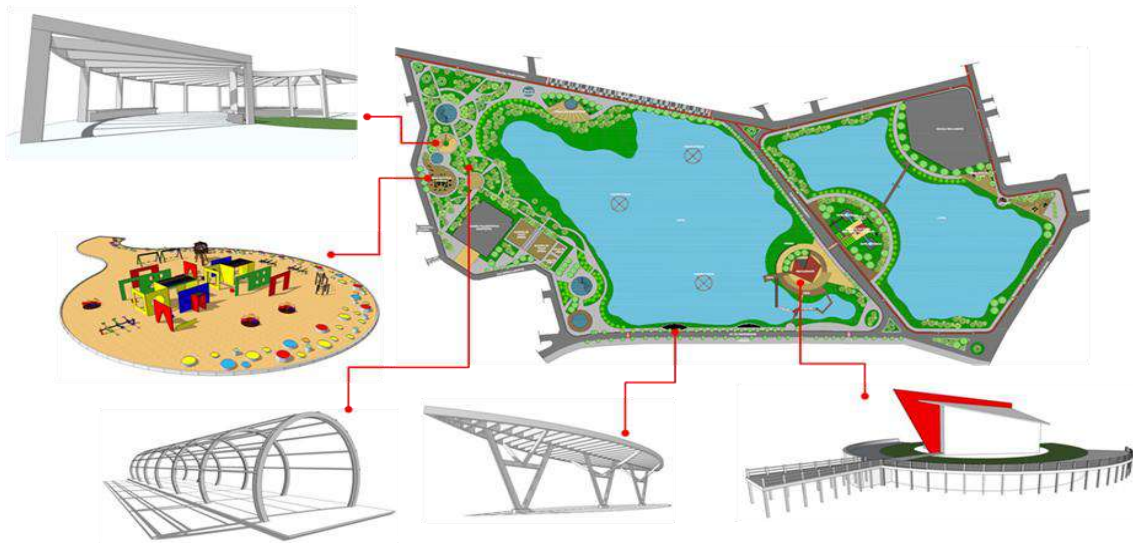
Vista Aérea da Localização do Parque Lagoa da Fazenda
